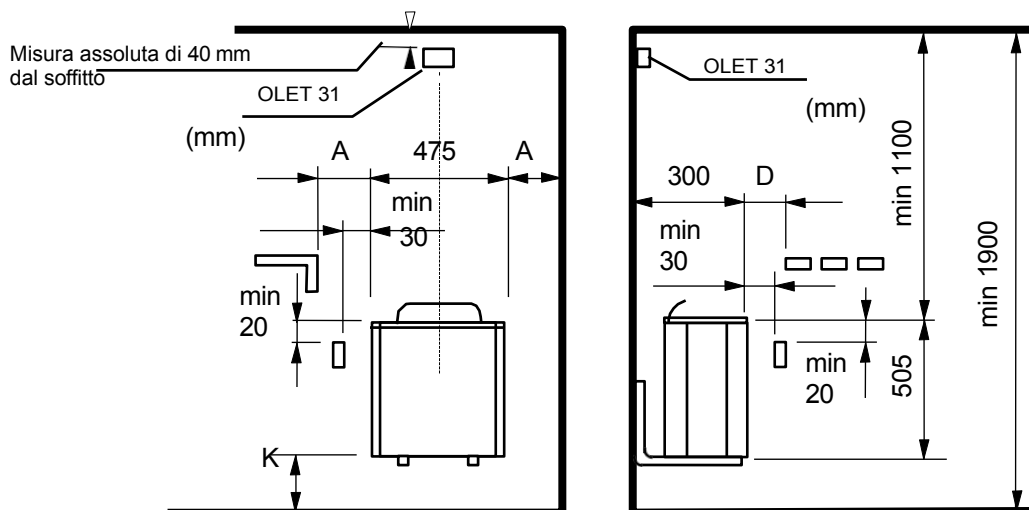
Distanze di sicurezza del riscaldatore e posizione del sensore rispetto alla parete a 40 mm dal soffitto
